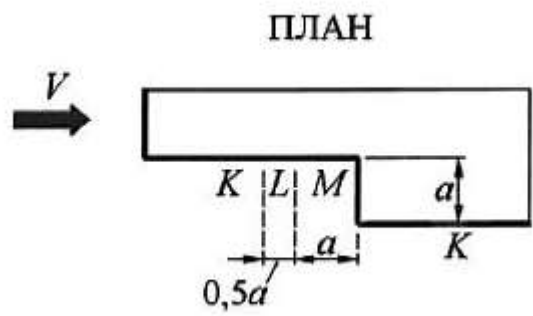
Схема задания ветровой нагрузки на стены для зданий с уступами.
